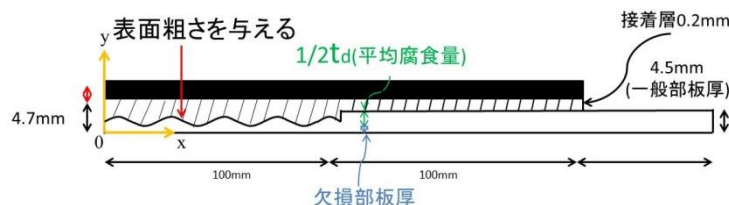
断面欠損部に表面粗さを持つ 1/4 モデル
